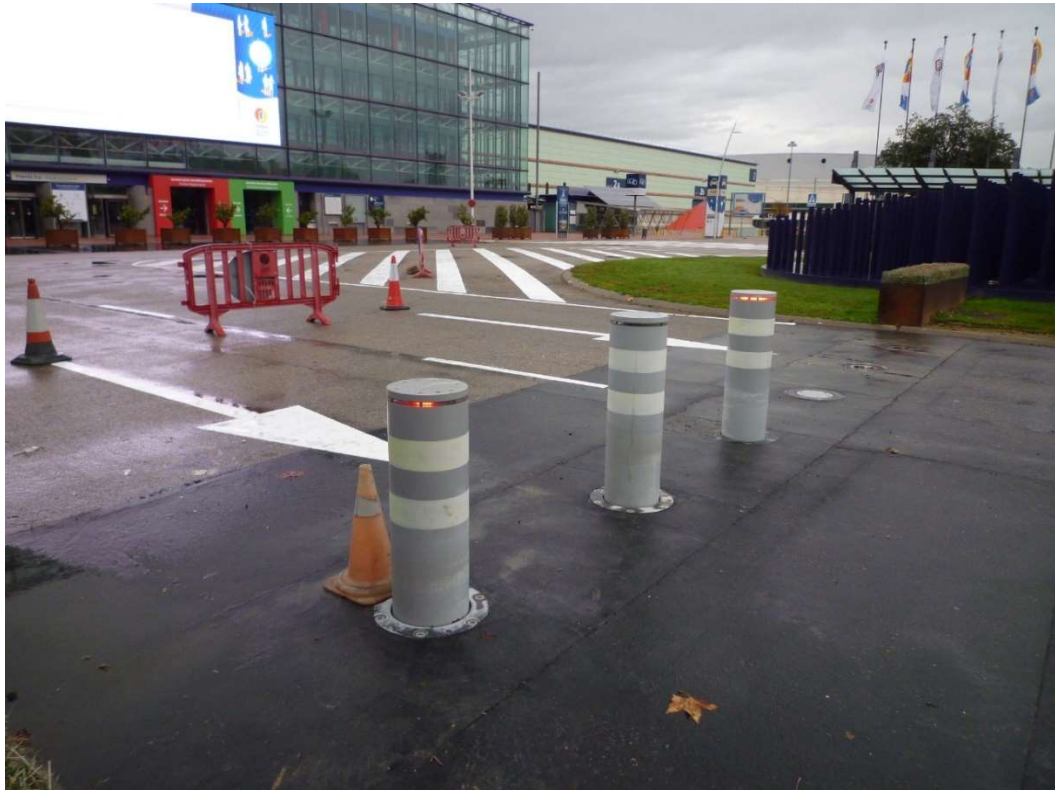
Fallos de leds en las coronas de las pilonas, acceso K1
